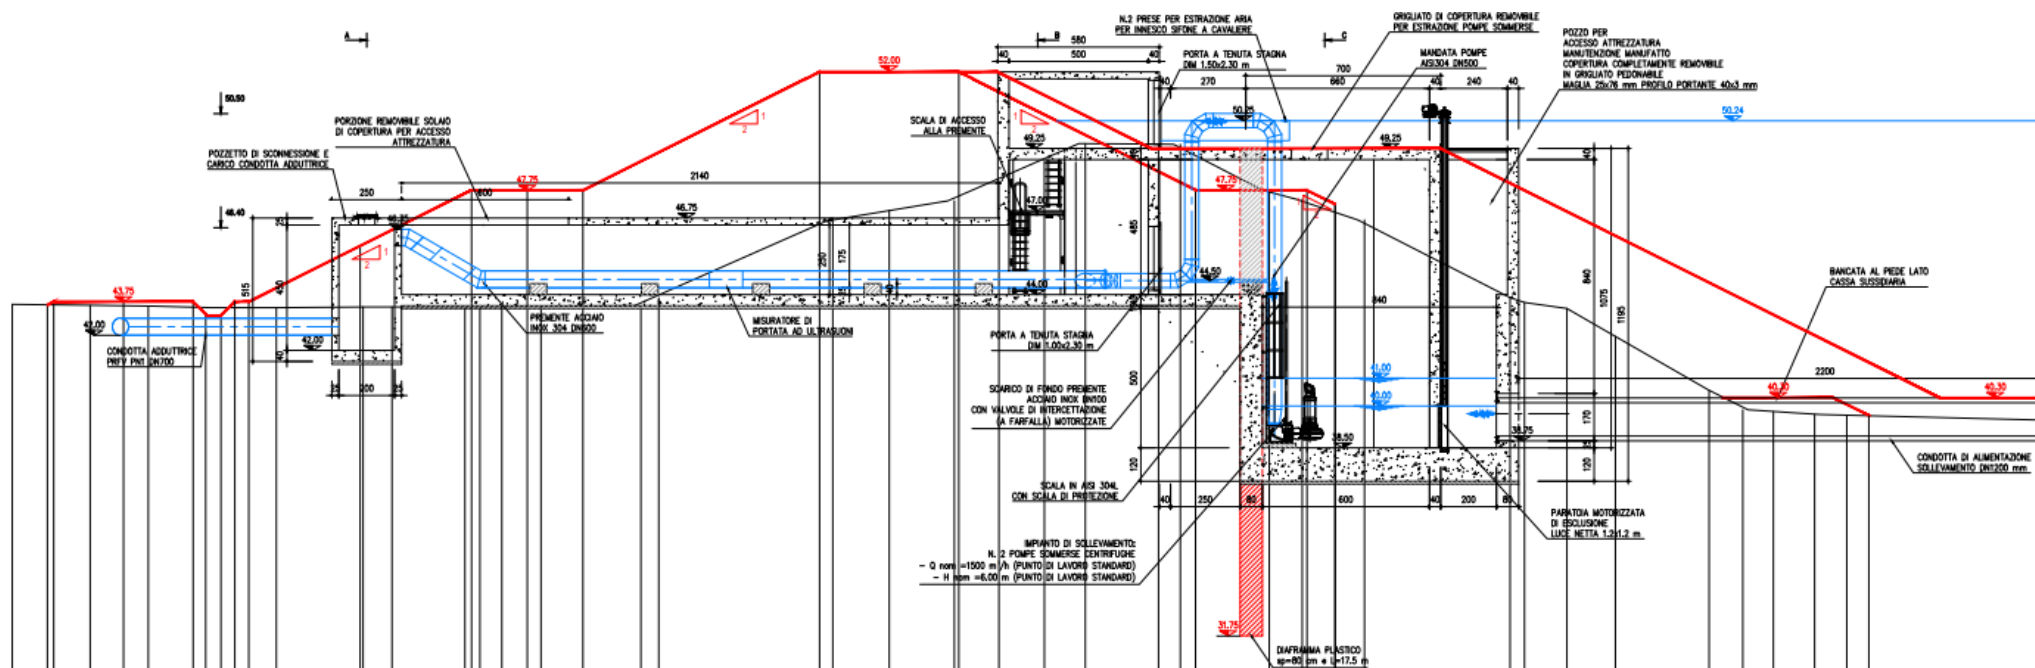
Stralcio della sezione di progetto raffigurante l'impianto di sollevamento e l'attraversamento arginale previsti nel IV lotto
